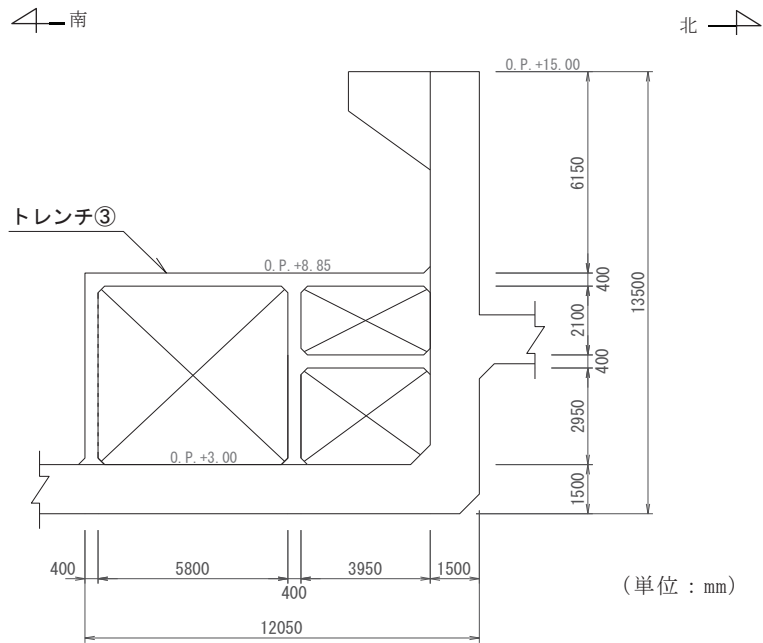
(9) 補機ポンプエリア断面図 (⑨—⑨断面)
